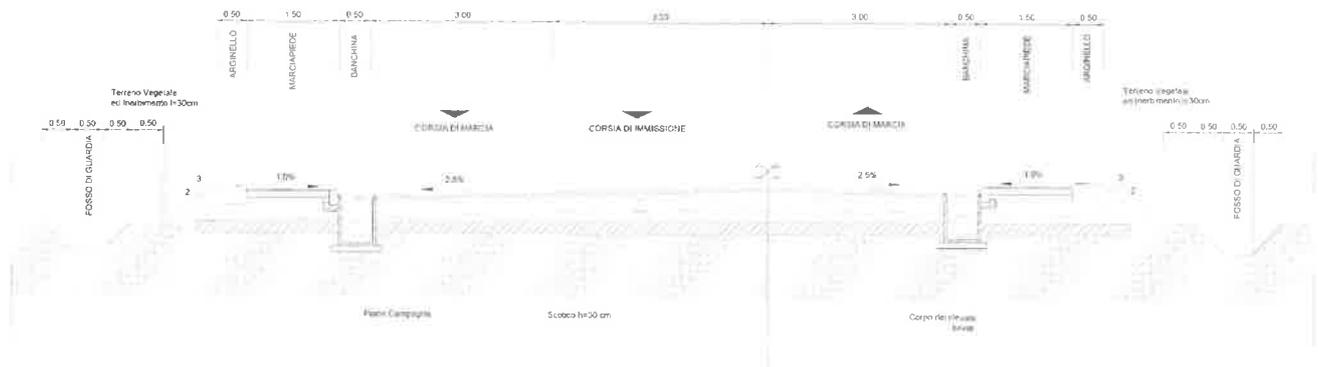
Sezione Tipo Rilevato tratto a 3 corsie compresa immissione
